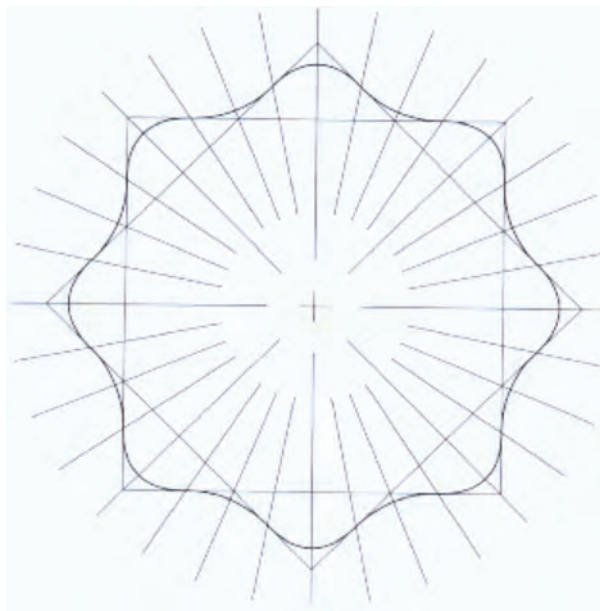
Secció de la base de la columna de la nau central (vuit elements).
